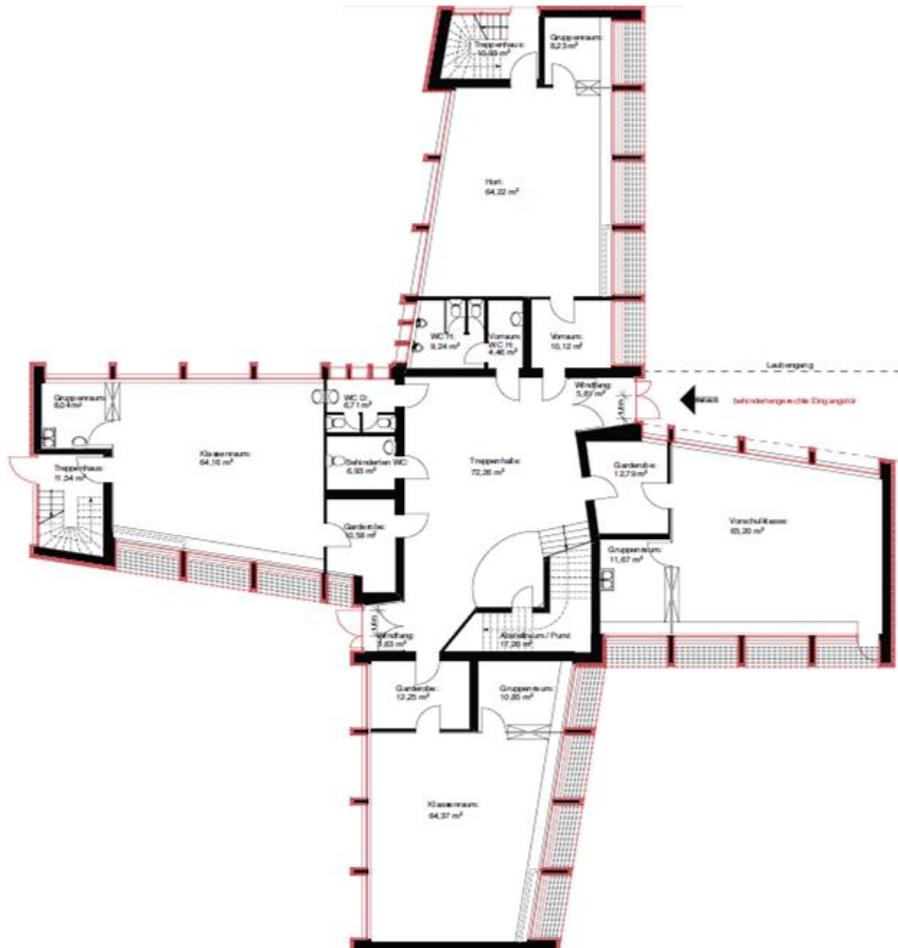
Kreuzbau Systemgrundriss⁷¹
